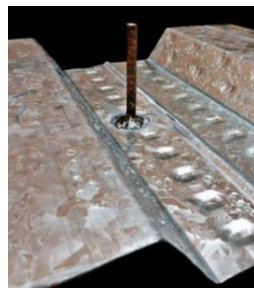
Conector tipo varilla soldado a la viga
